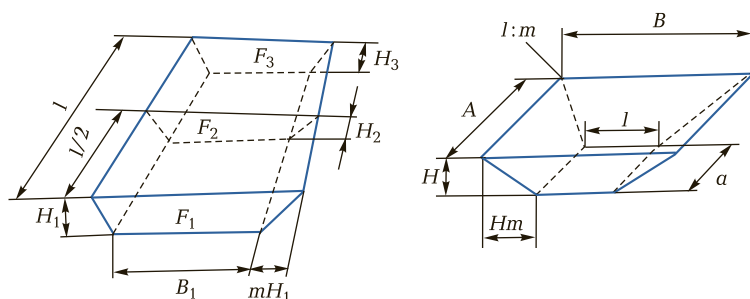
Схемы расчета объемов земляных работ по котлованам
